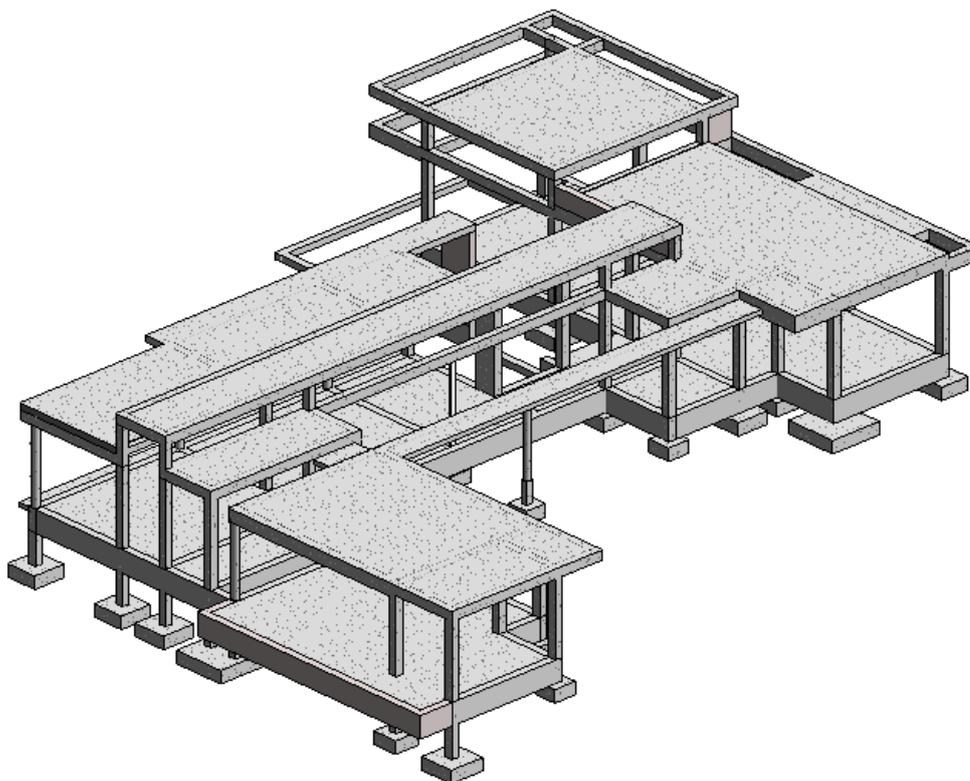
Elementos de fundação, vigas e lajes do projeto de execução, Revit
